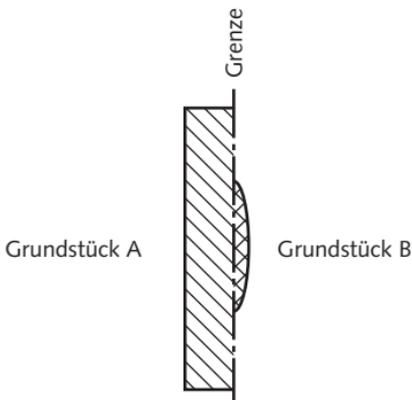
Ausbuckelung als Überbau (Grundriss)
